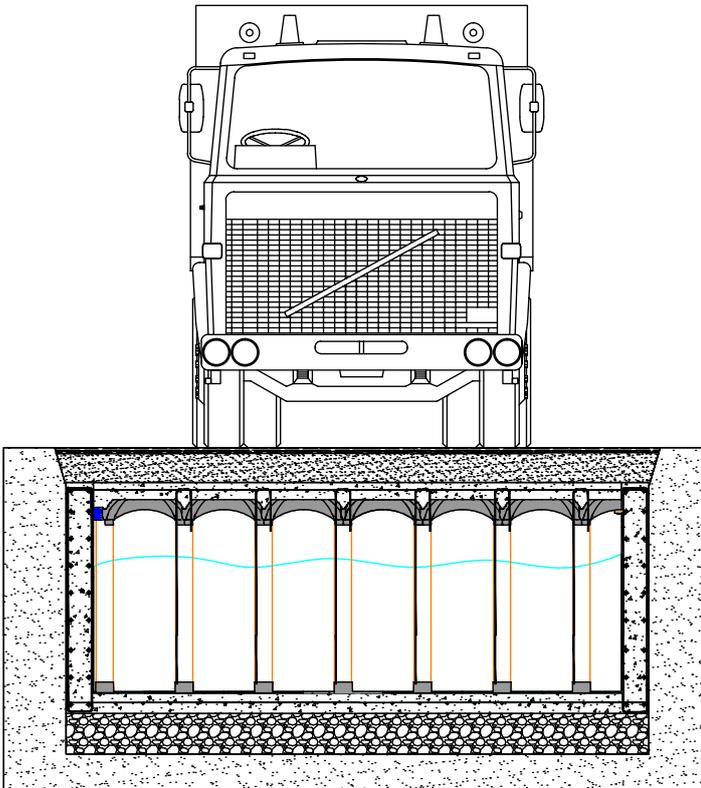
Sezione vasca NUOVO ELEVETOR TANK
